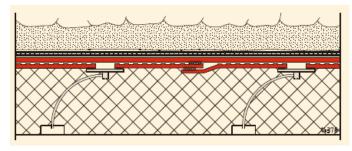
Solapes, soldadura y disposición de los tubos
